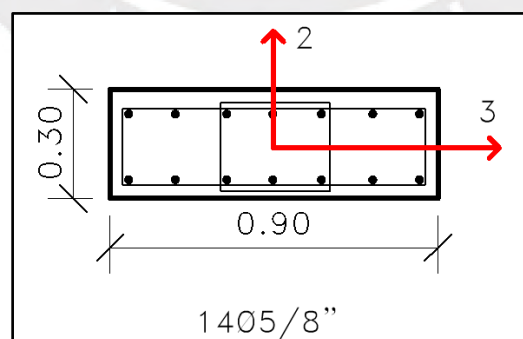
Direcciones locales y armado inicial de la columna esquinera
